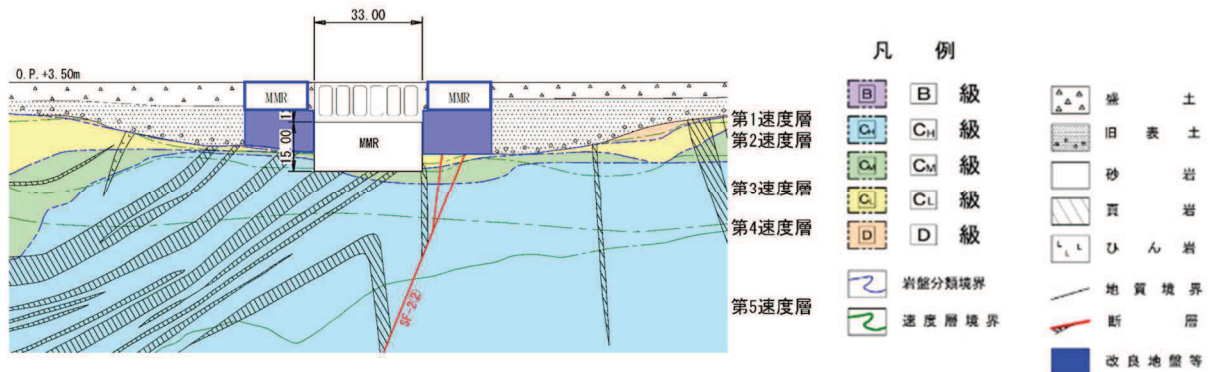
地盤改良体の配置図 (取水口, A-A 断面)
